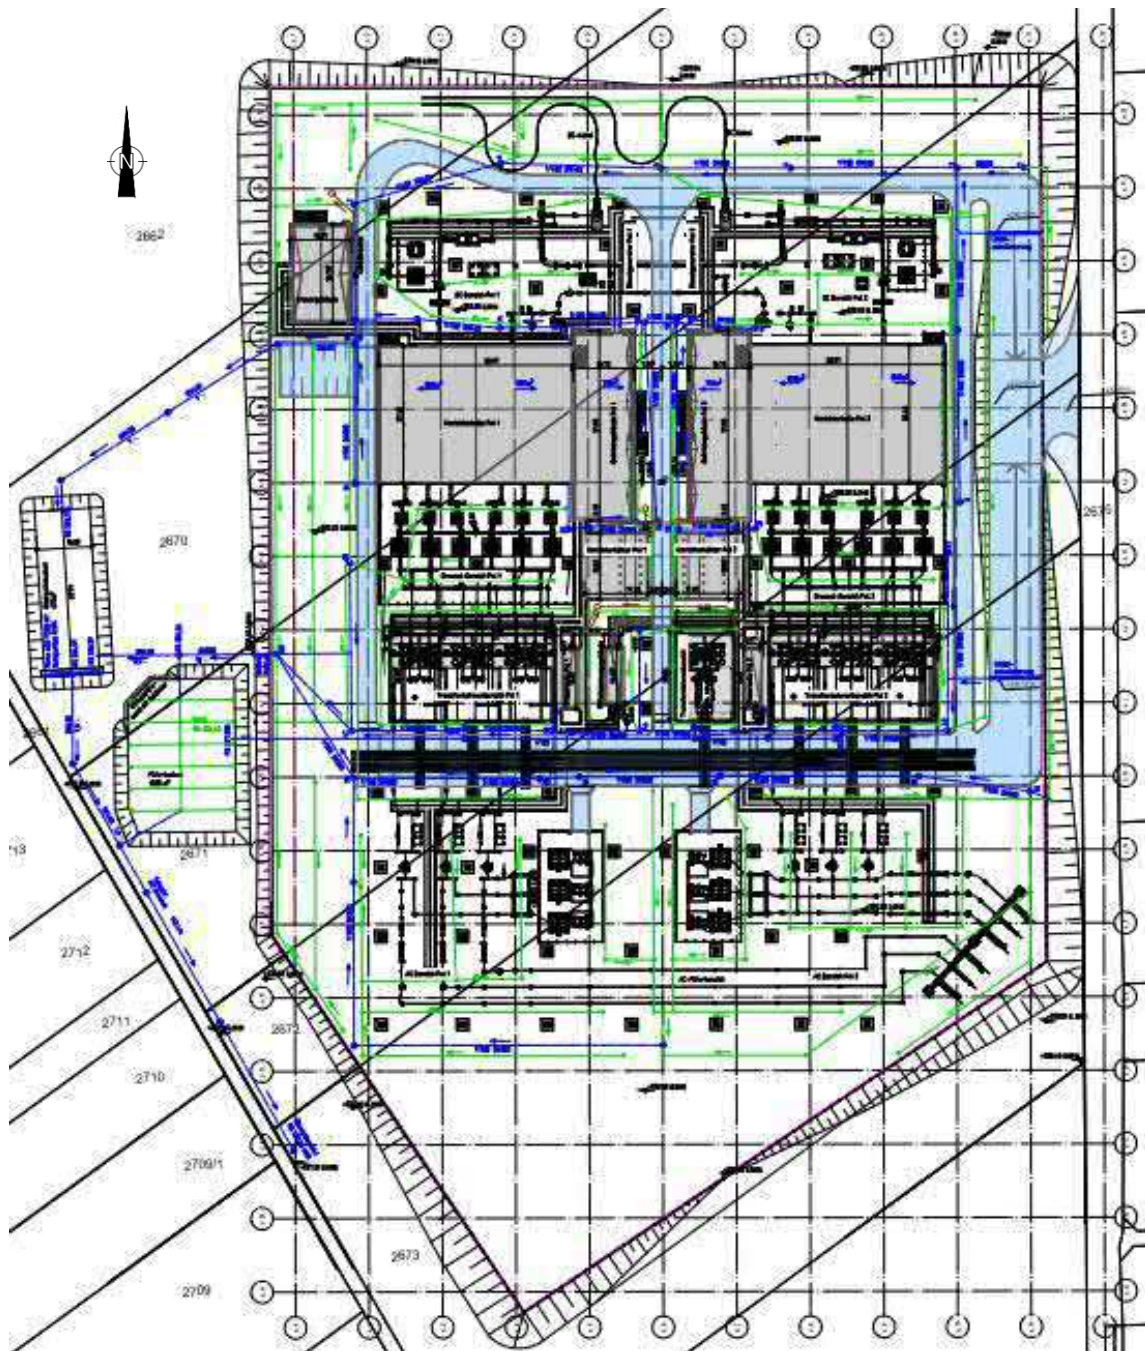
Detailplan der Konverterstation mit Darstellung des Entwässerungssystems (in grün: Leitungen der Flächendrainage, in blau: Entwässerungsleitungen) [U4]
